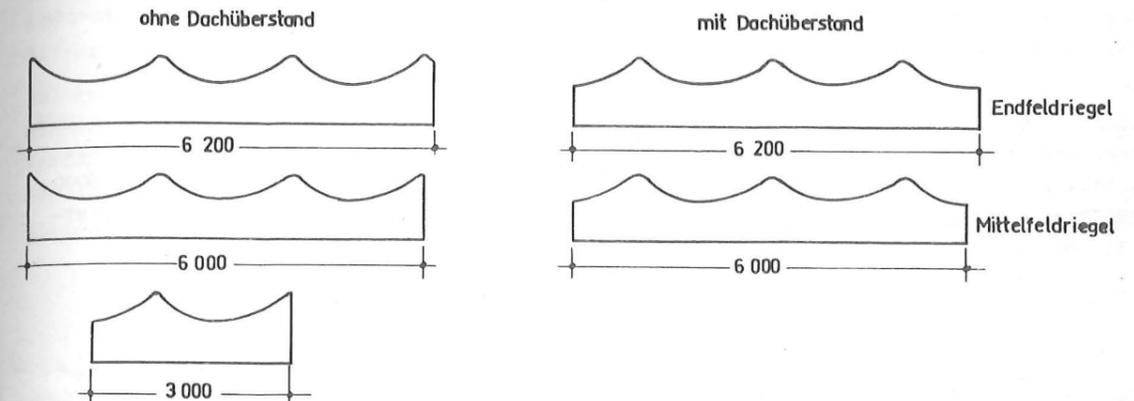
Längsriegel in Stahlbeton, SL 6000 mm
